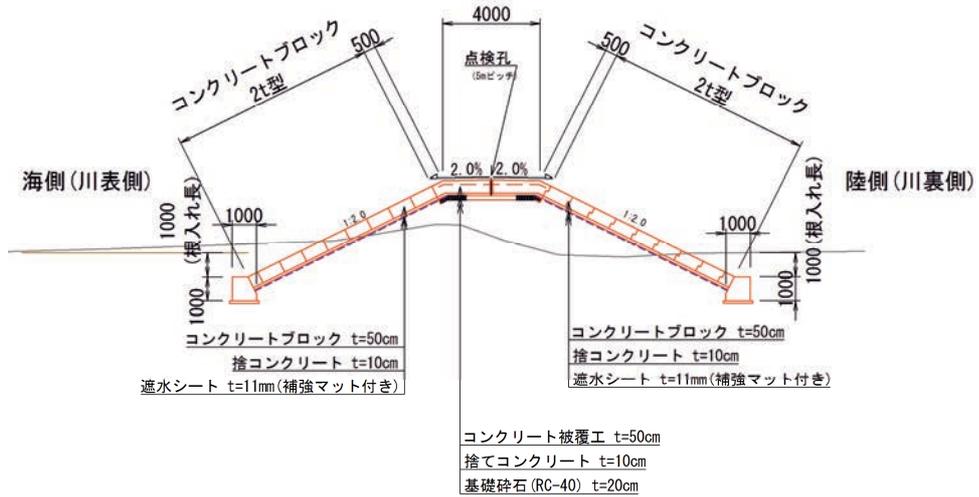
連結方法（不透過型 コンクリート被覆）
